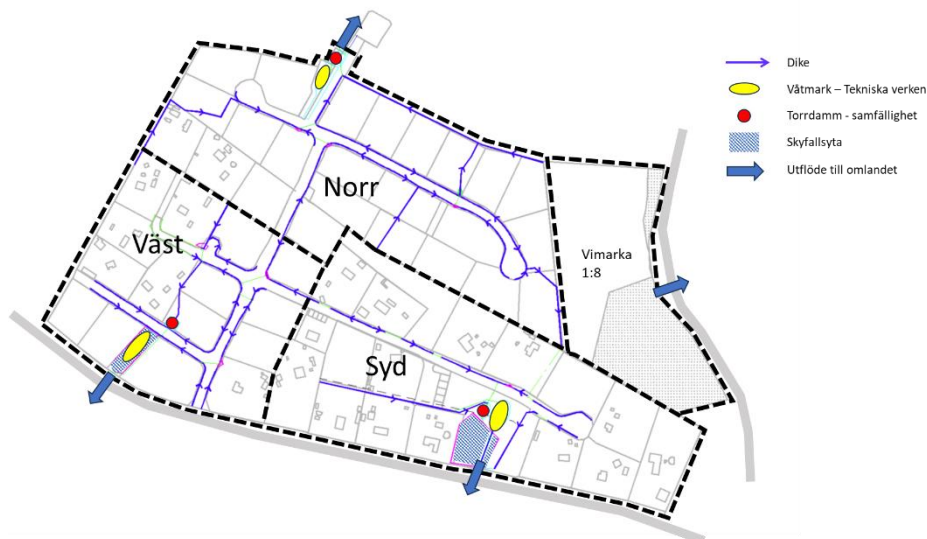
Översikt över föreslagna åtgärder utifrån dagvattenutredning och förprojektering – Ytbehov dagvattenhantering Vimarka. (källa: Ramboll, 2022 och WSP 2025). Avrinningsområdena som ingår i planområdet är markerade med svart streckad linje.
